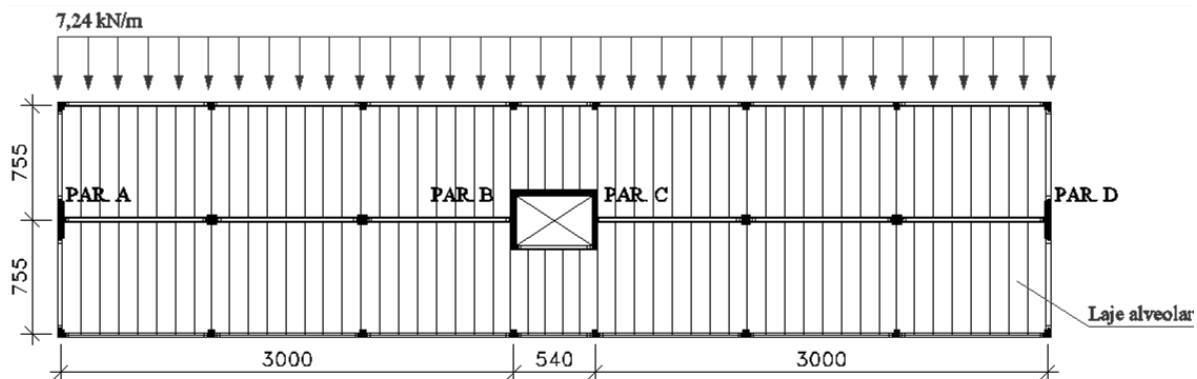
10 – Pavimento com ação considerada para seu dimensionamento como diafragma rígido.
